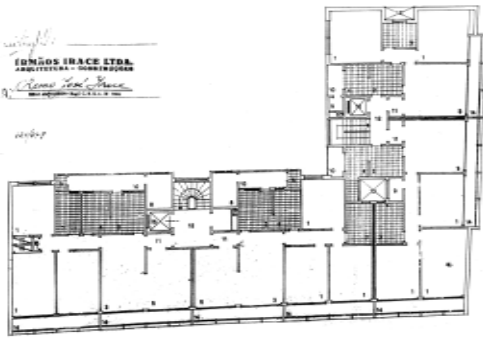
Planta baixa do pavimento tipo do Edifício Paglioli, dos Irmãos Itrace (1951).
